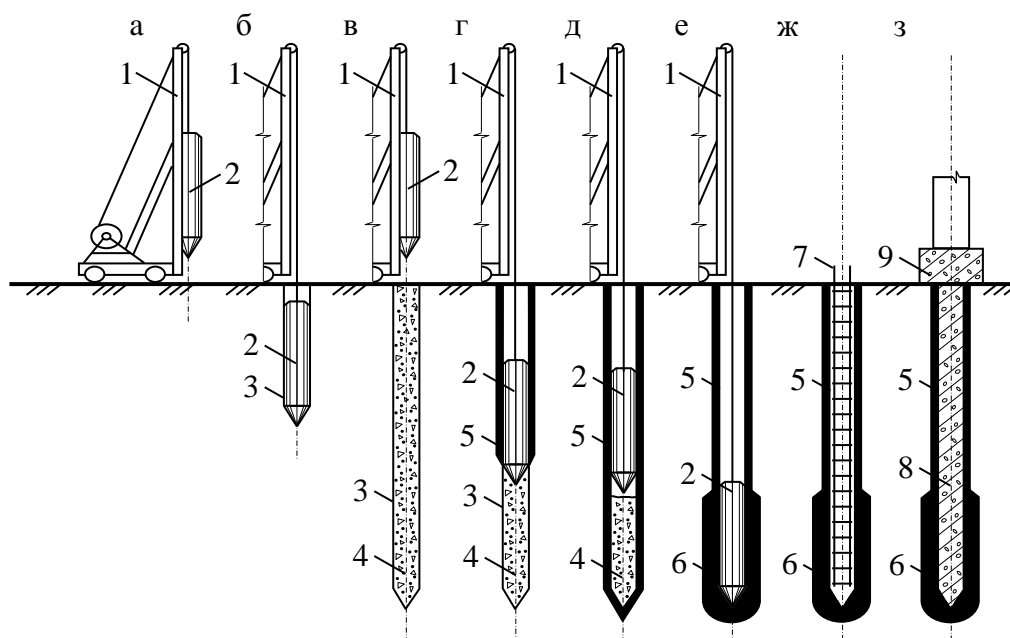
Схема влаштування набивних паль за допомогою пневмопробійників: а – центрування пневмопробійника; б – пробивання свердловини; в – заповнення свердловини бетоном; г – влаштування бетонної оболонки; д, е – влаштування розширення; ж – установлення арматурного каркаса; з – готова палля з ростверком; 1 – стартовий пристрій; 2 – пневмопробійник; 3 – свердловина; 4 – бетон; 5 – бетонна оболонка; 6 – розширення; 7 – арматурний каркас; 8 – залізобетон; 9 – ростверк
